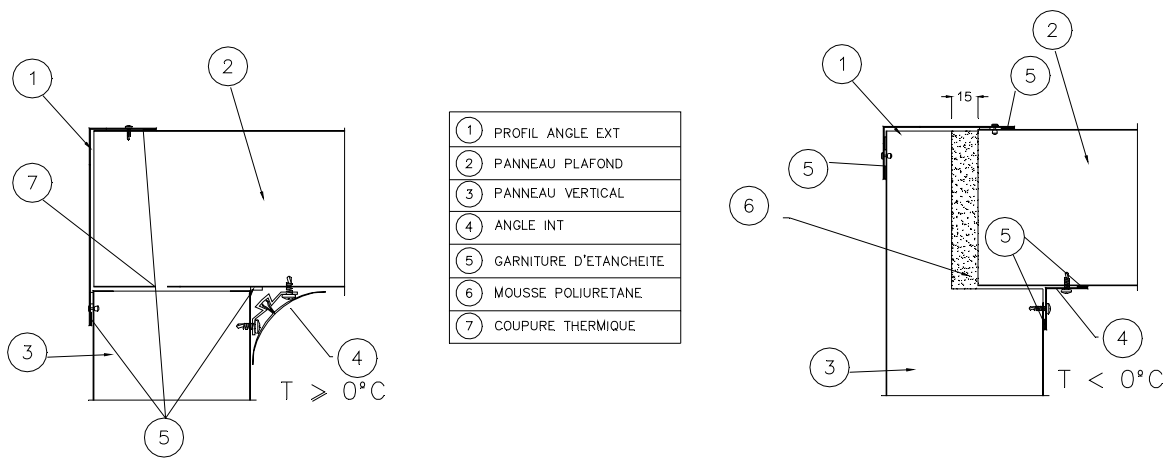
Jonction paroi-plafond - Paroi non porteuse (Pour montage à mi-bois panneau de paroi d'épaisseur minimale 100mm)
